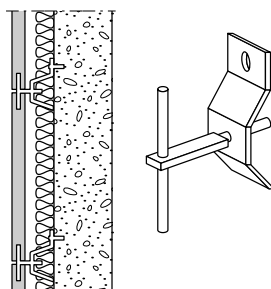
Agrafes de fixation utilisées avec les plaques de parement de façade. Logements. Paris
